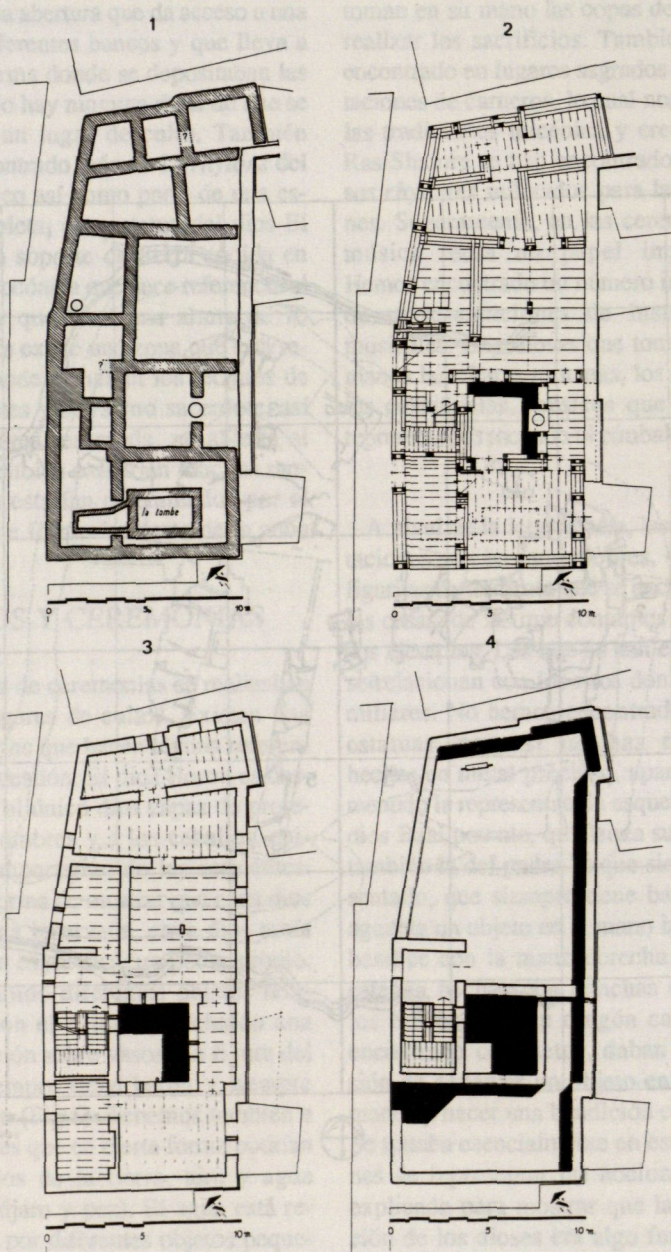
Casa A de la isla VI en la "Ville Sud": 1) Cimentación; 2) Planta baja; 3) Piso; 4) Terraza.
